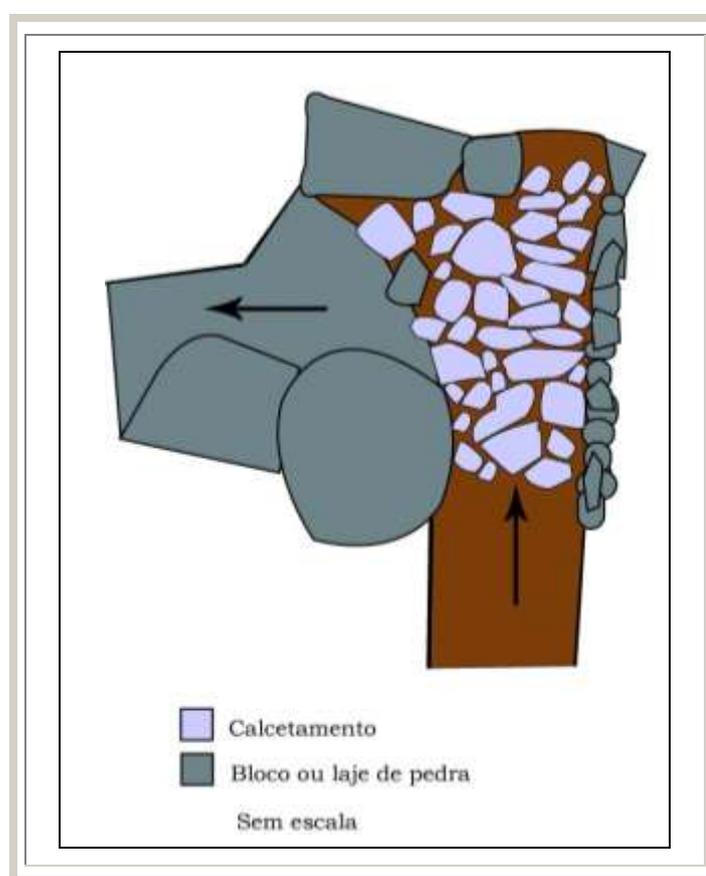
Planta baixa da área calçada no subtrecho A1, pt-03
